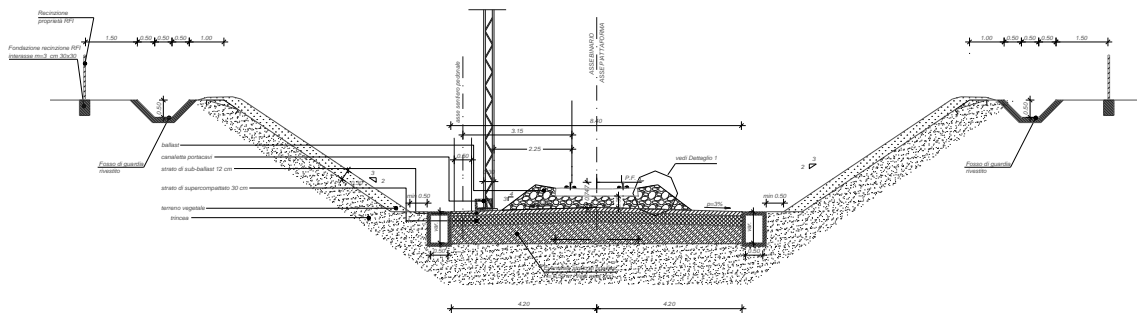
Sezione tipo ferroviaria in trincea a singolo binario in rettilo
